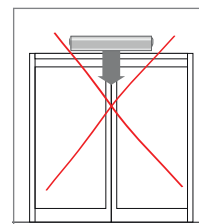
Der Luftstrom muss die gesamte Öffnung abdecken.
